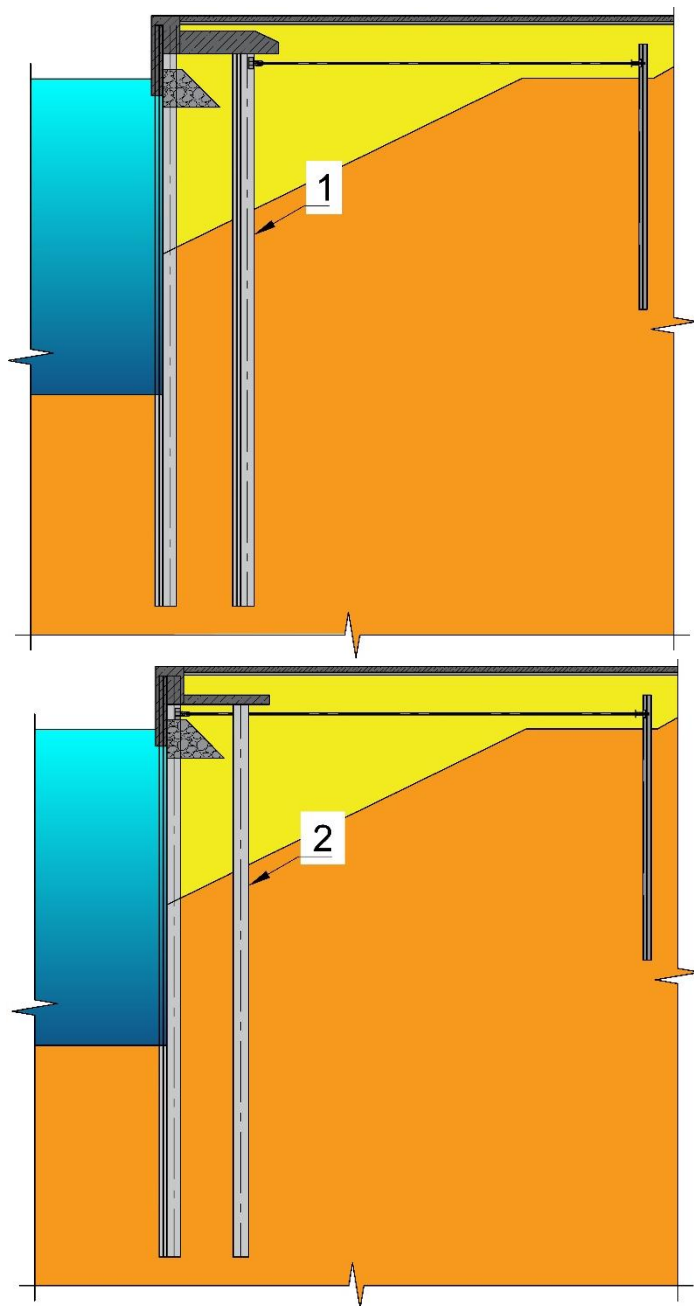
Причальные сооружения с анкеровкой за экранирующую стенку (а) и за лицевую стенку (б): 1 – экранирующая шпунтовая стенка; 2 – экранирующие сваи.
